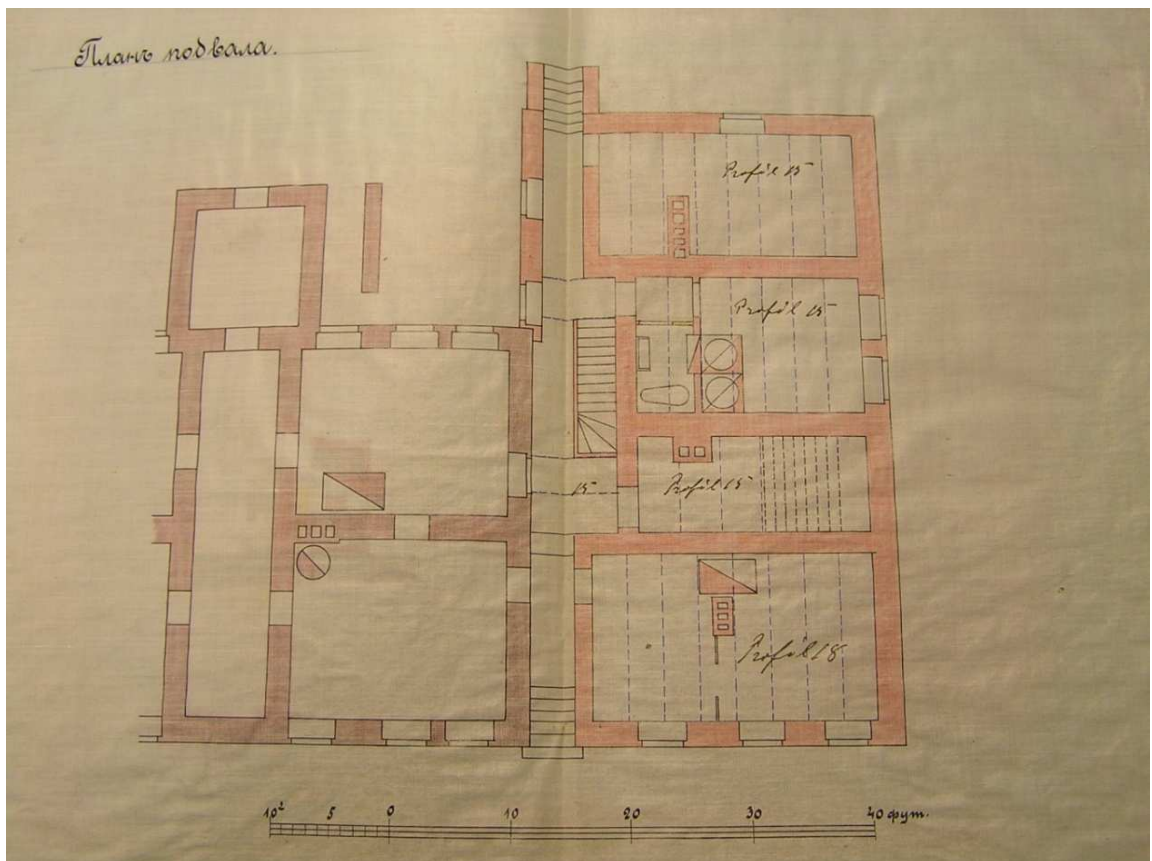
juurdehituse keldri plaan, 1912. a – foto arhiividokumendist
